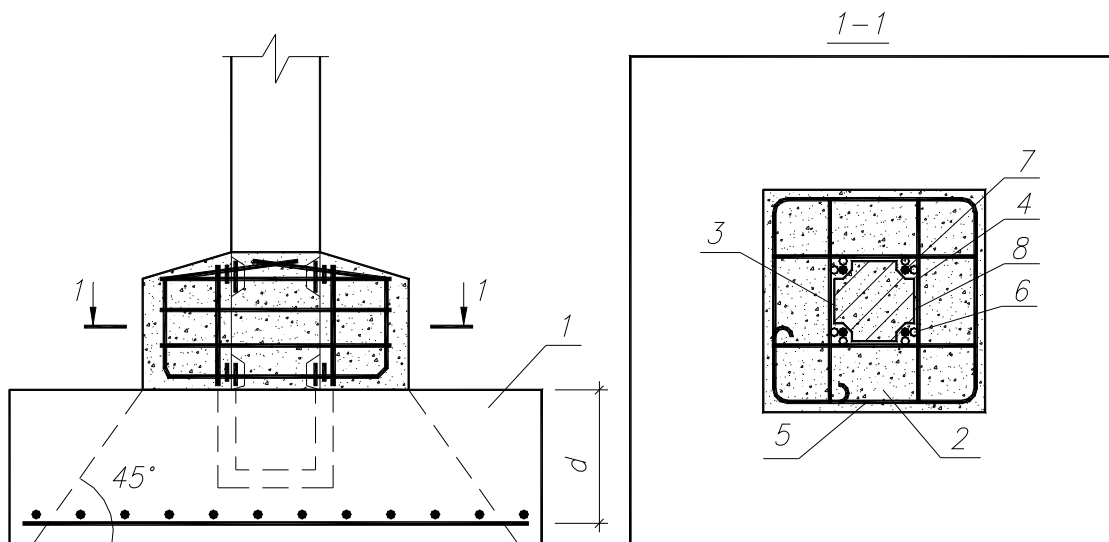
Усиление при продавливании устройством опорной железобетонной обоймы:
